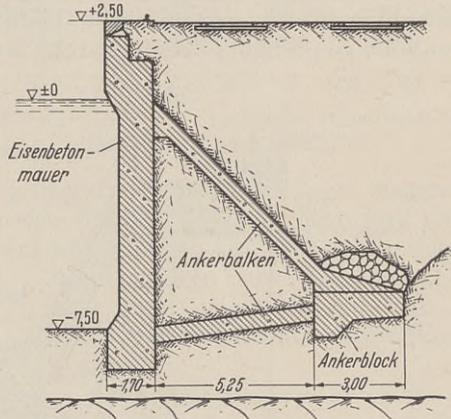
Eisenbetonkonstruktion, Ausführung im Trockenen, Industriehafen Malmö.
